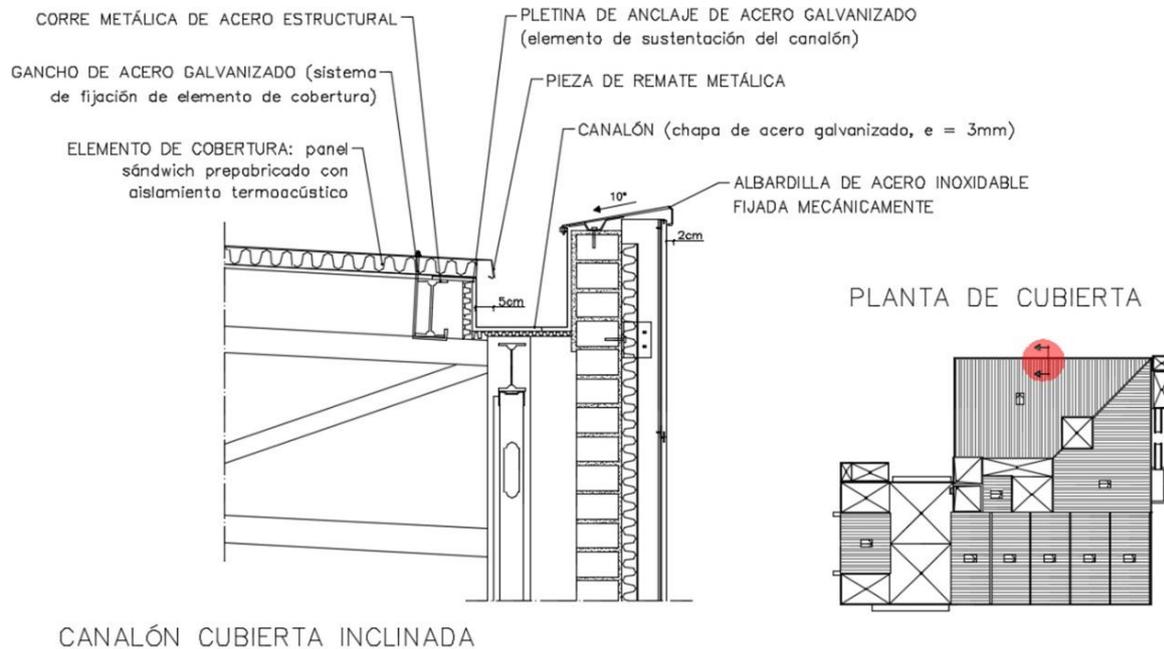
Esquema canalón oculto (cubierta inclinada, nave II). Fuente: elaboración propia.
